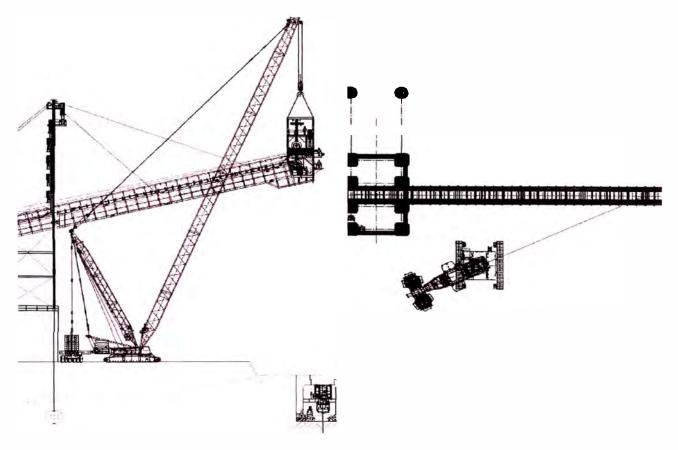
Ubicación de grúa LR 1400-2 montaje de sección 5
